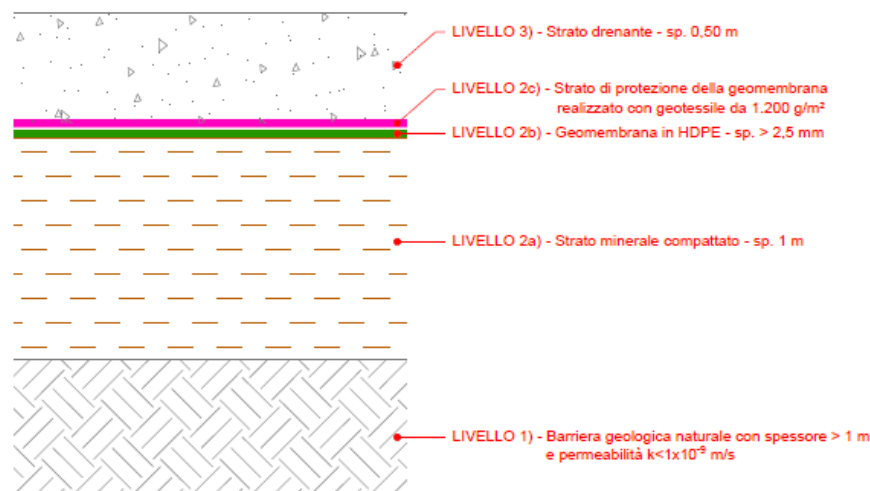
Pacchetto di fondo invaso di Tipo 2
